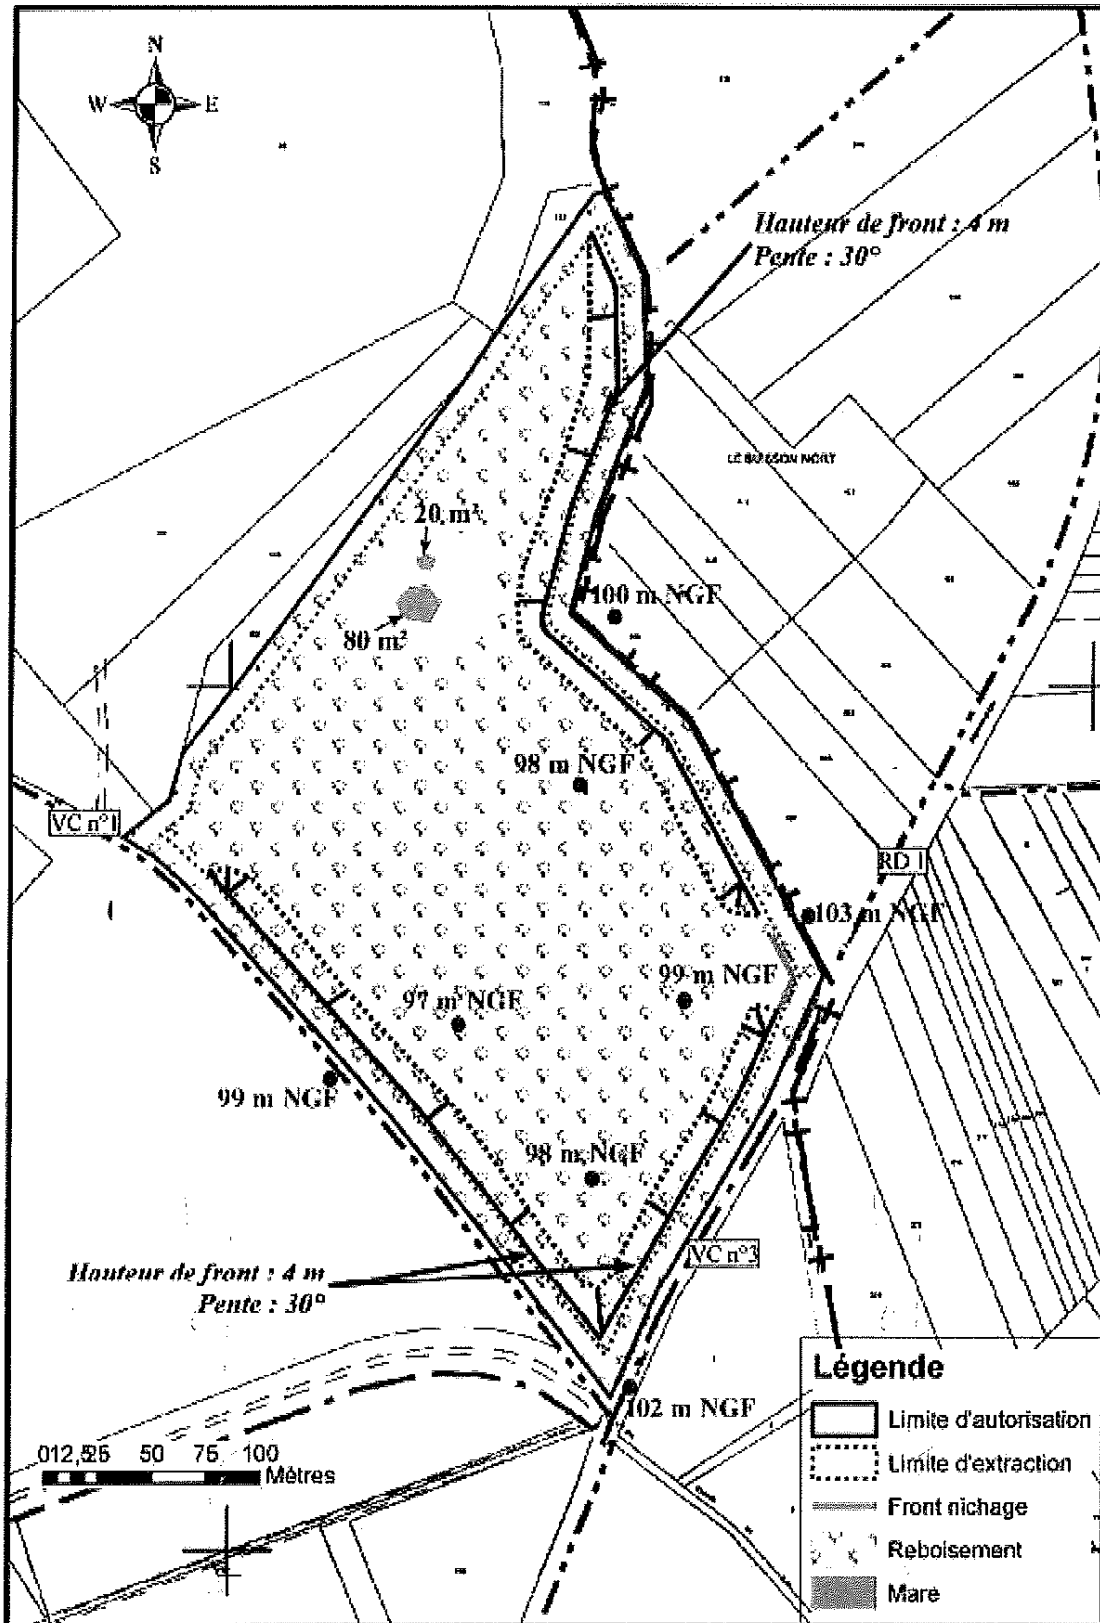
PLAN DE L'ETAT FINAL
